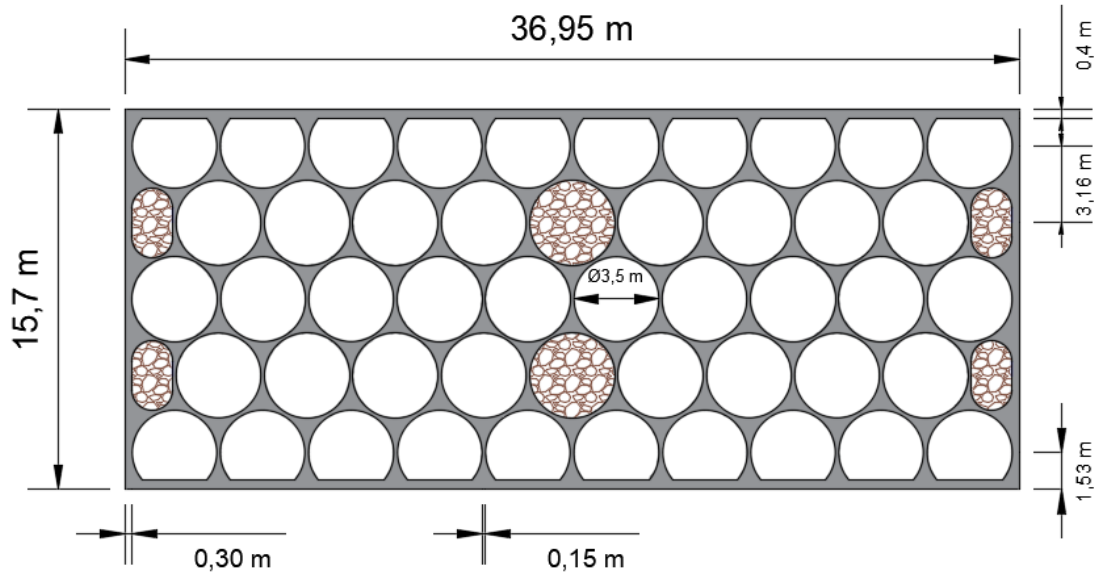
Geometría del cajón antirreflejante en planta. Fuente: Propia
